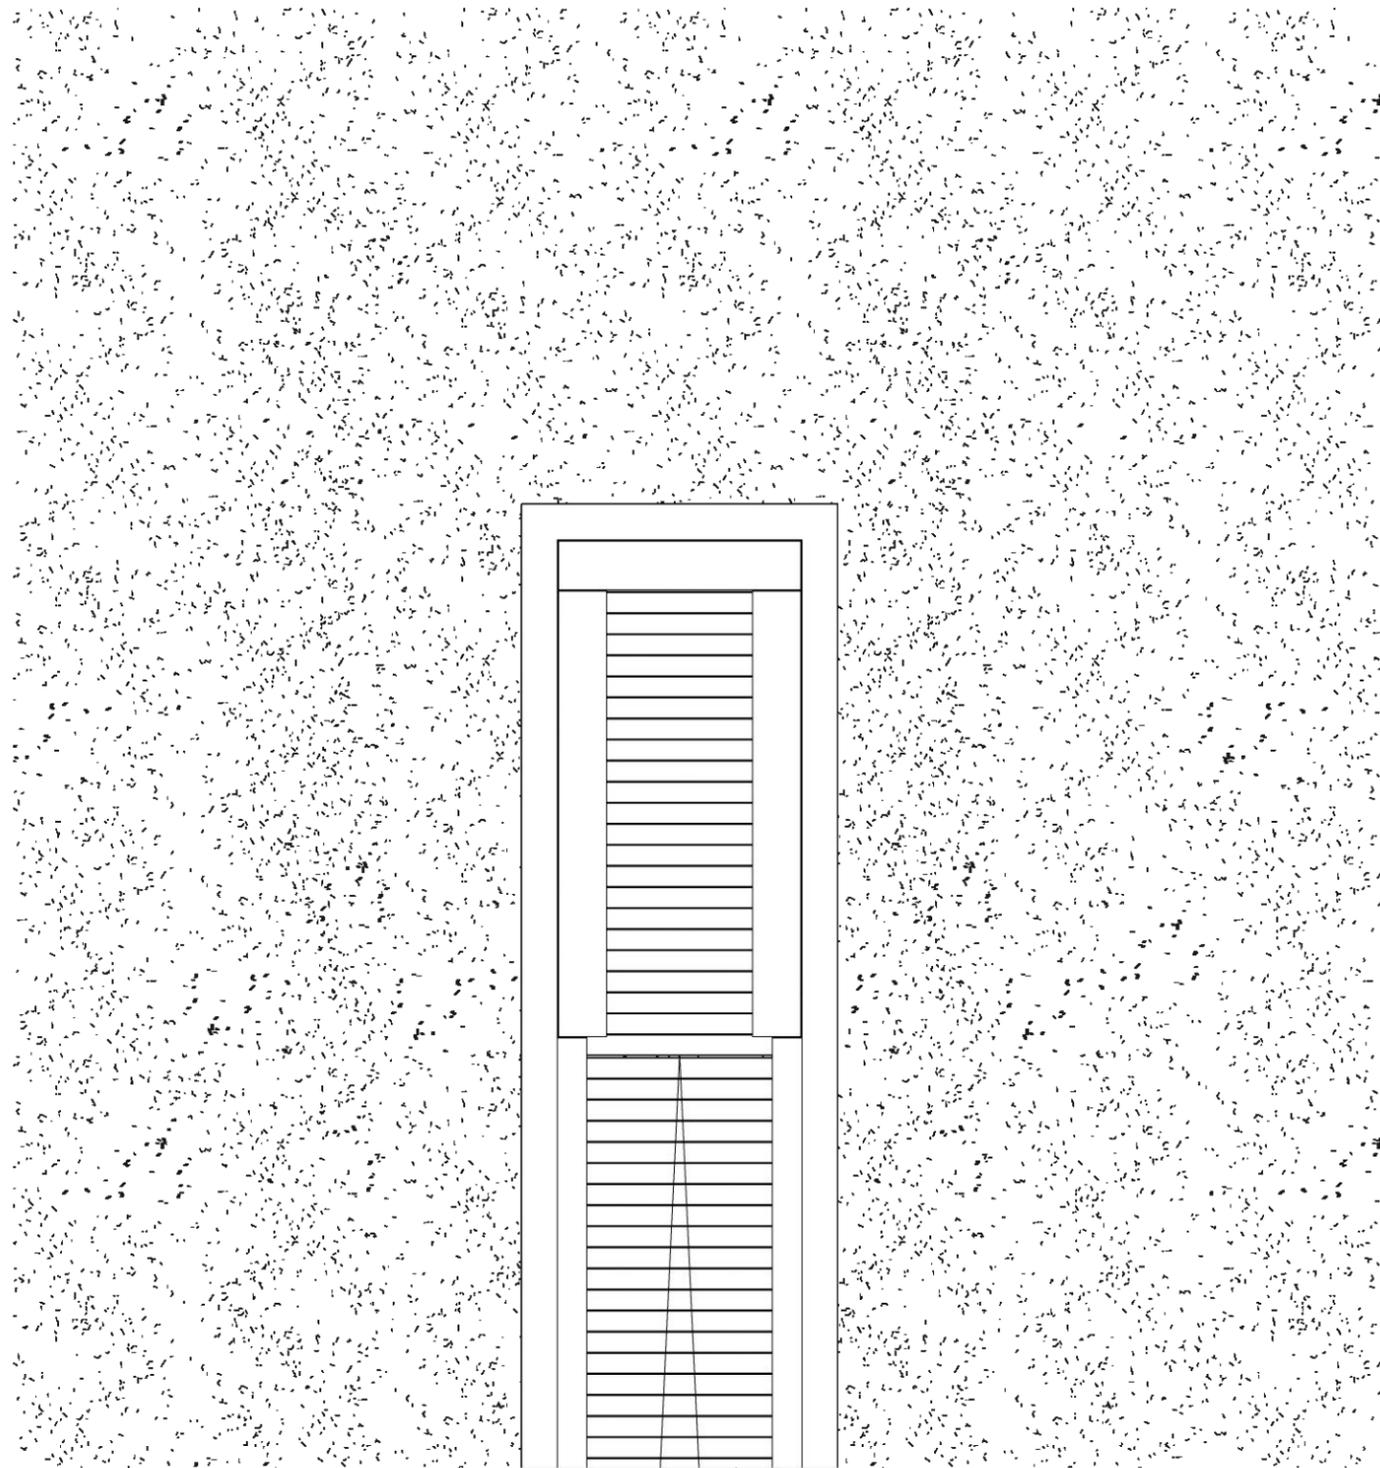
Wegweiser 3; Grundriss M 1:75
